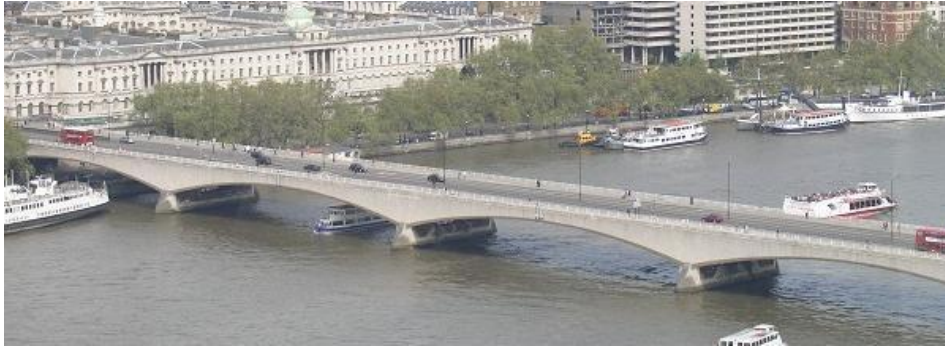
Ponte Waterloo em Londres, vista geral [3]
